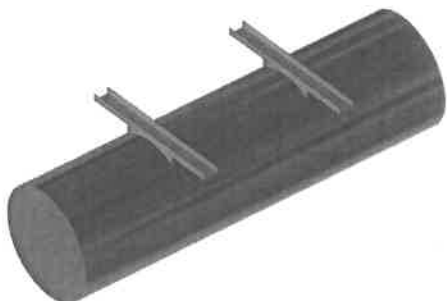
Общий вид наплавной опоры круглого сечения
